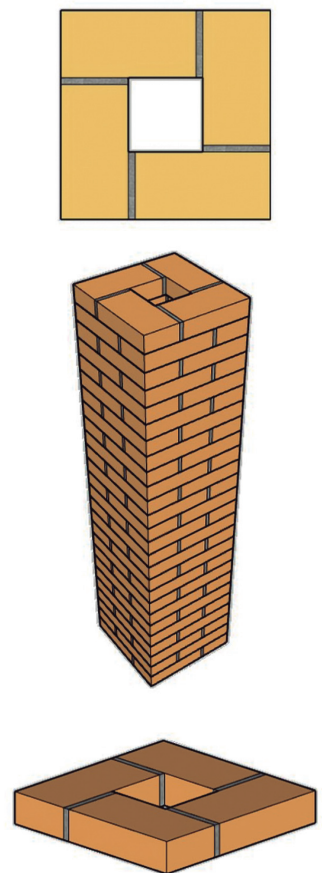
Aparejo tipo estructural en planta e isométrico. De los autores a partir de sistemas de modelado, 2018.
